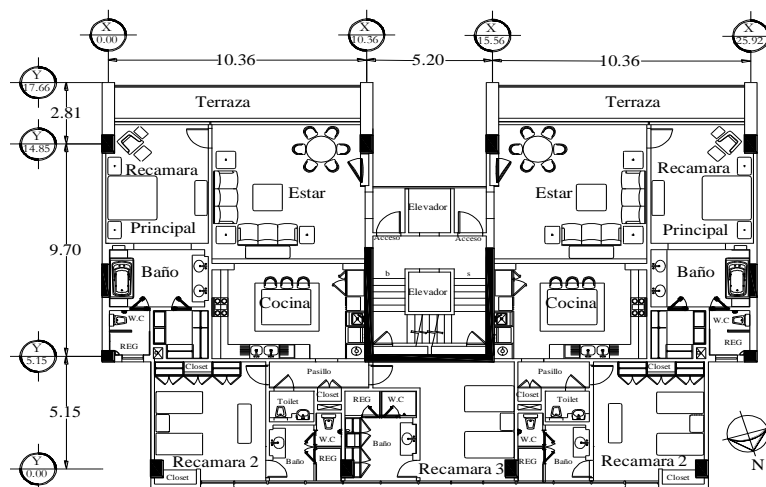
Planta Arquitectónica del 3ro al 12vo. Nivel.
